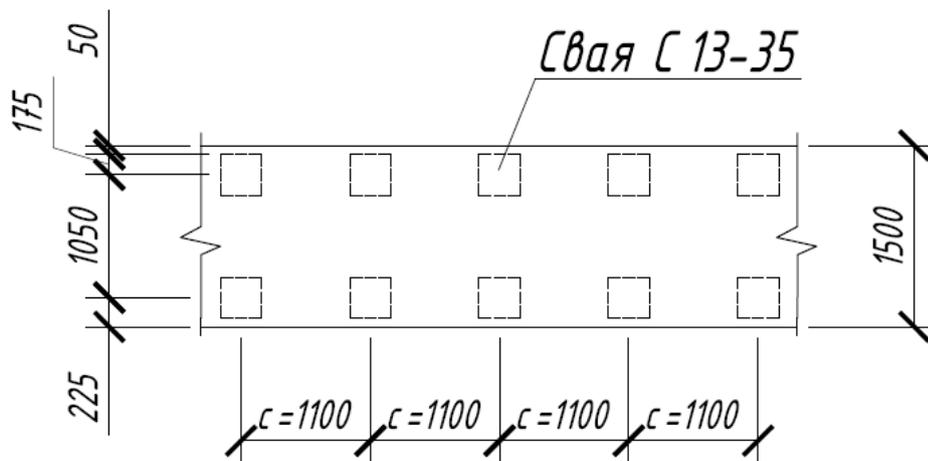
Фрагмент ростверка под наружные стены здания
